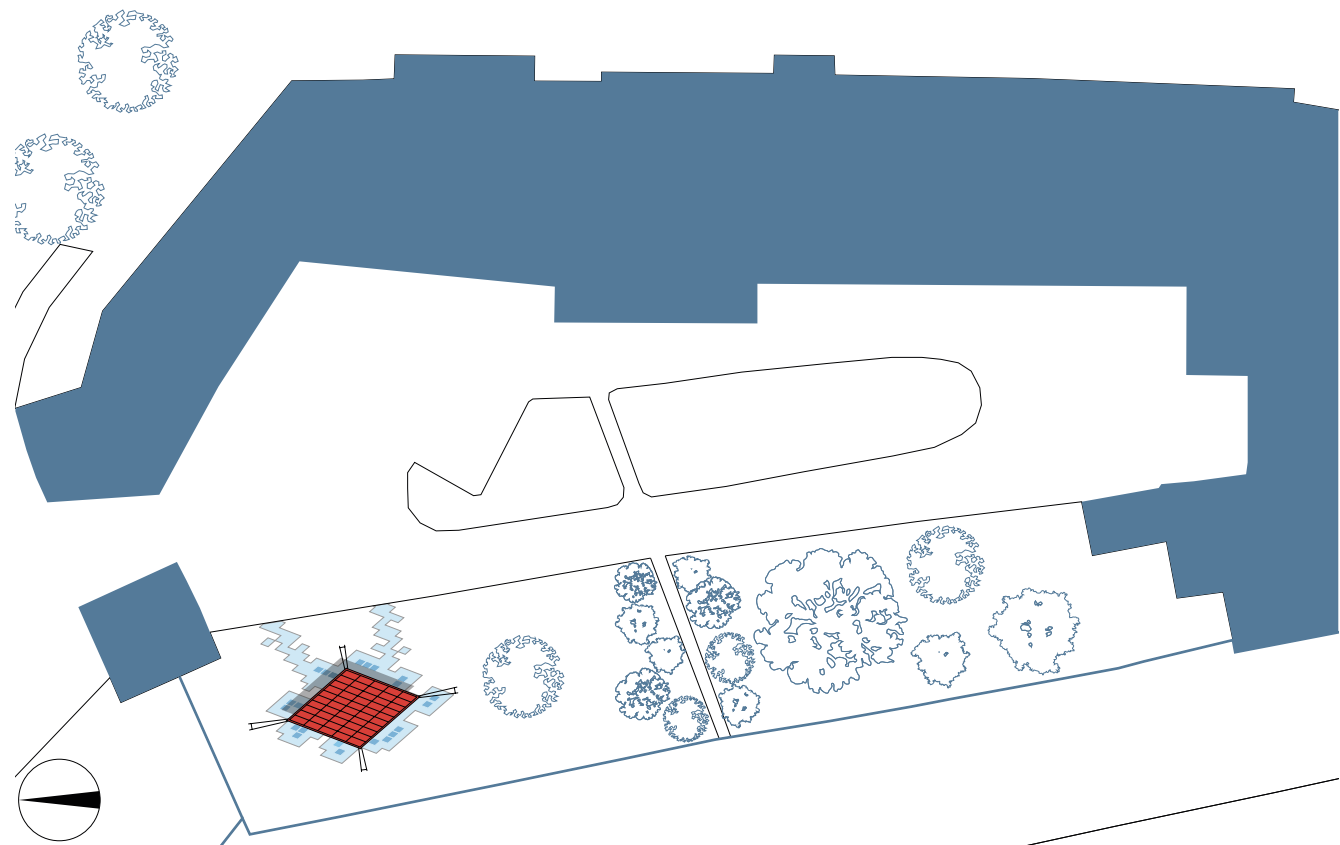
Lageplan Bauplatz Umgebung | M 1:500
